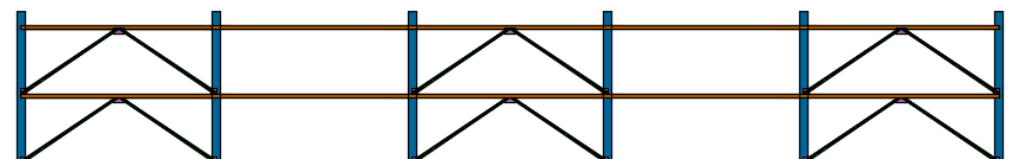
Arriostramiento lateral de armaduras y vigas
